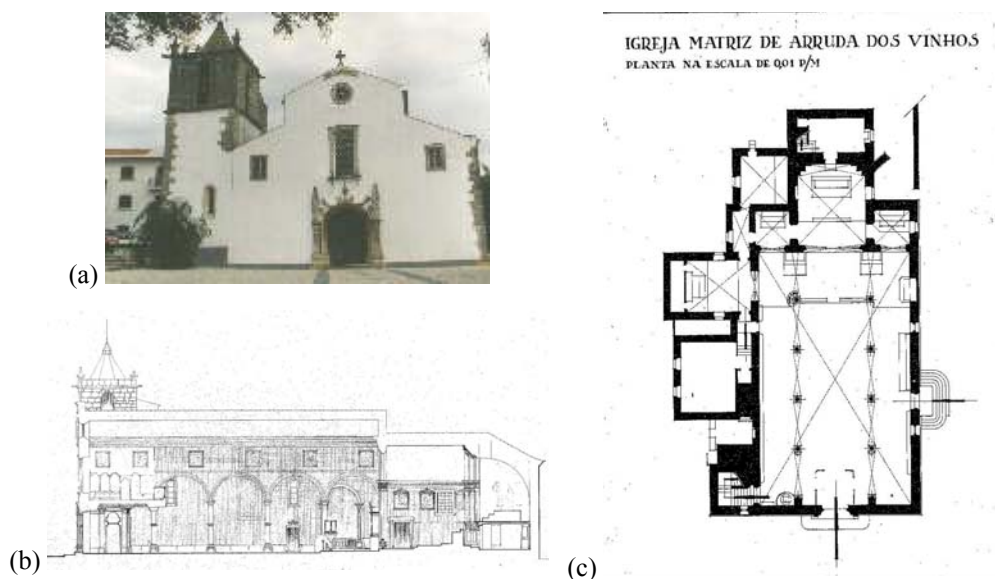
Peças desenhadas [Fonte: DGEMN]: (a) fotografia; (b) corte longitudinal; (c) planta.
